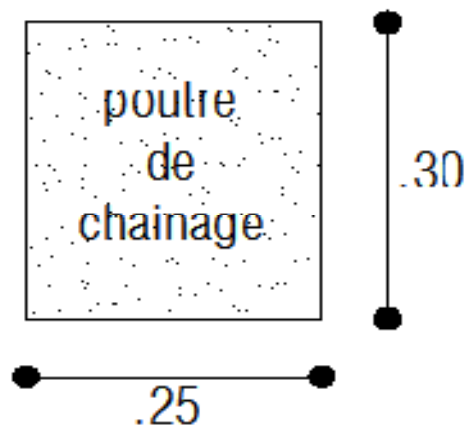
dimensions de la poutre de chaînage
